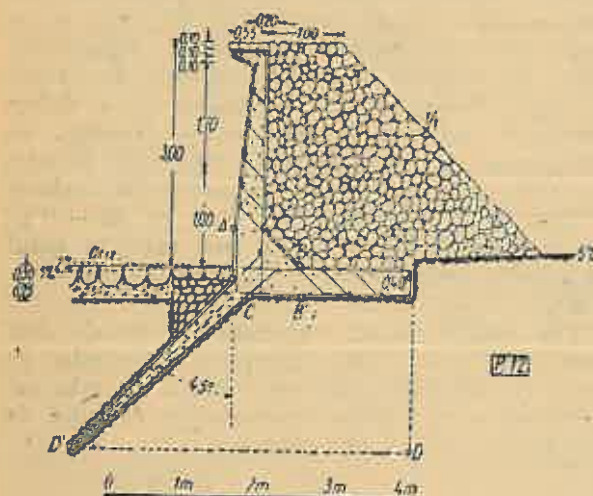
Baraj din beton armat pentru albiu din pământ necoerent.
